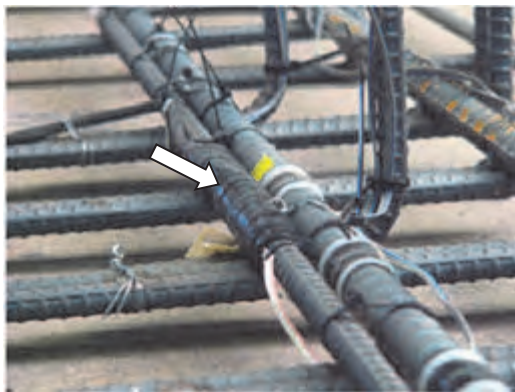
コンクリート配筋に設置した RFID タグ用のひずみ検知部
